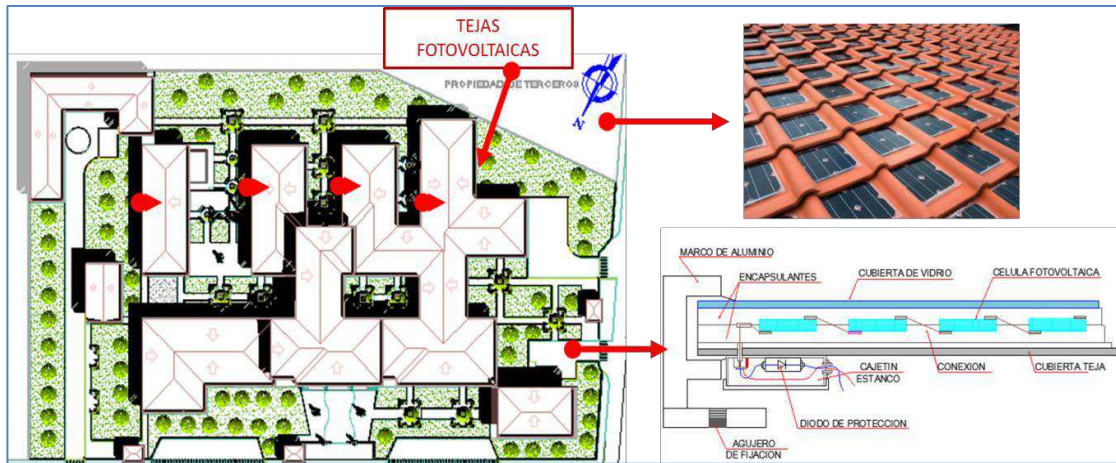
Planteamiento Tejas Fotovoltaicas; Fuente: elaboración propia
